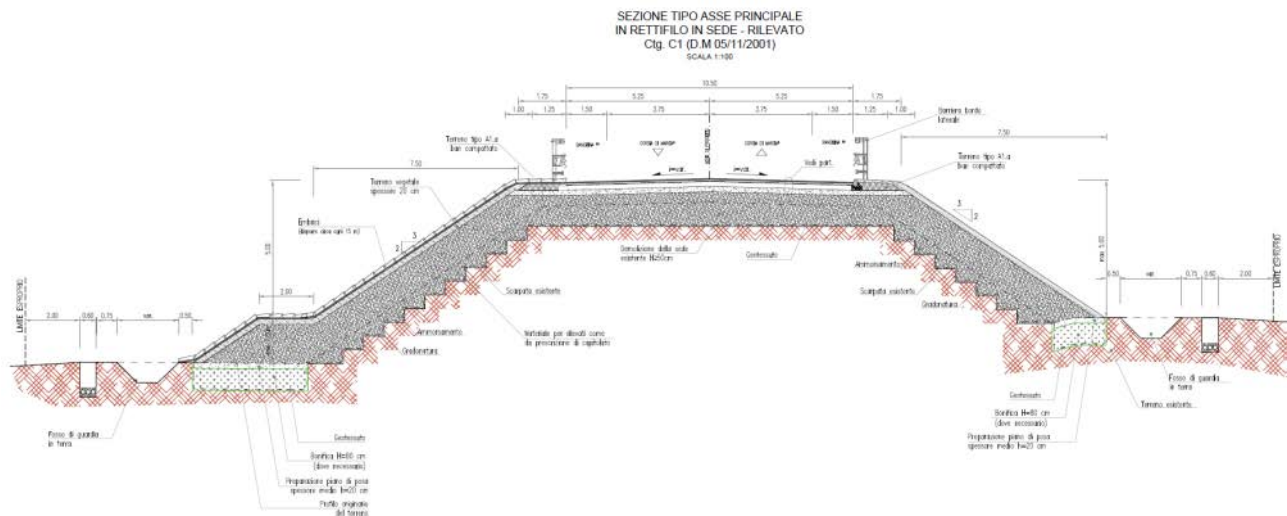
Sezione Tipo in Asse Principale in rettilo in sede
